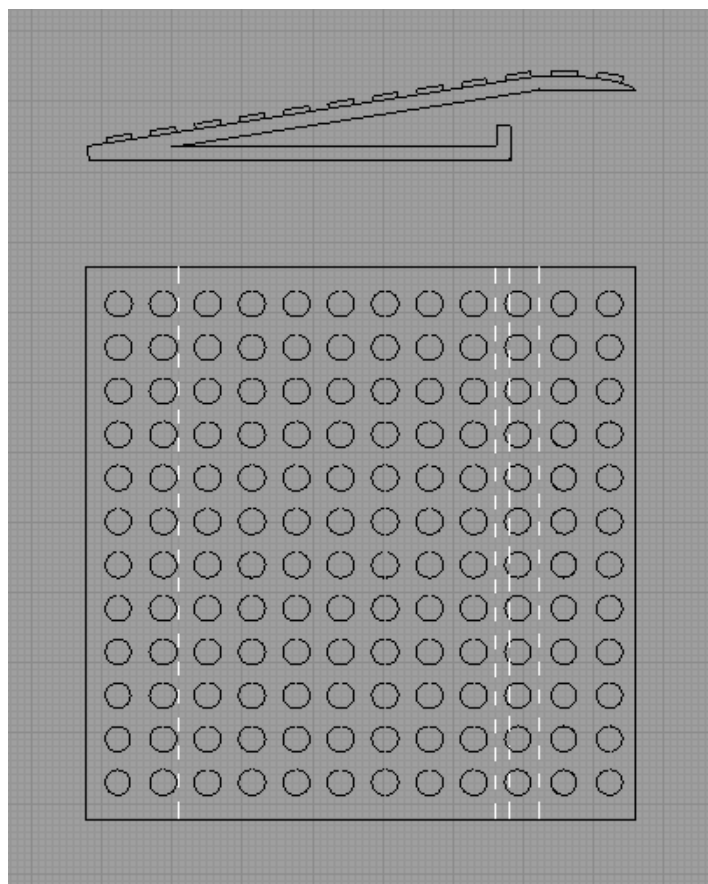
Planimetría Rampa Diseño Accesible. Elaboración propia.
